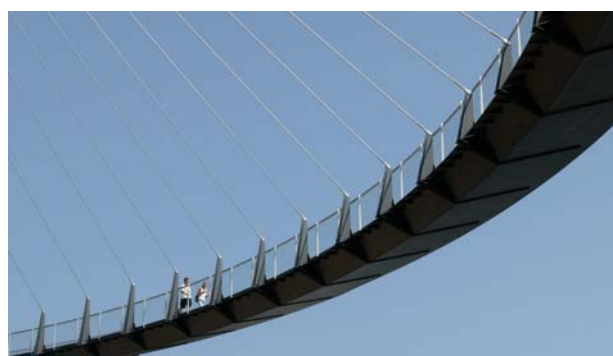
Visutá lávka přes Harbor Drive v San Diegu, Kalifornie, USA
